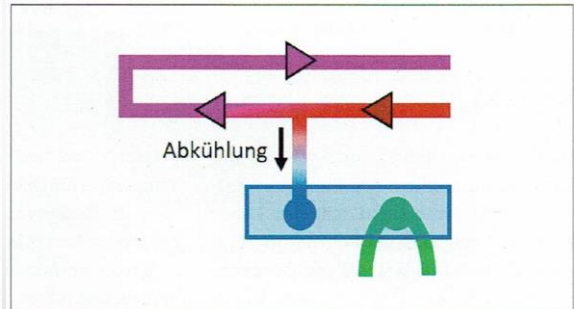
Prinzip eines thermisch getrennten Armaturenanschlusses.
